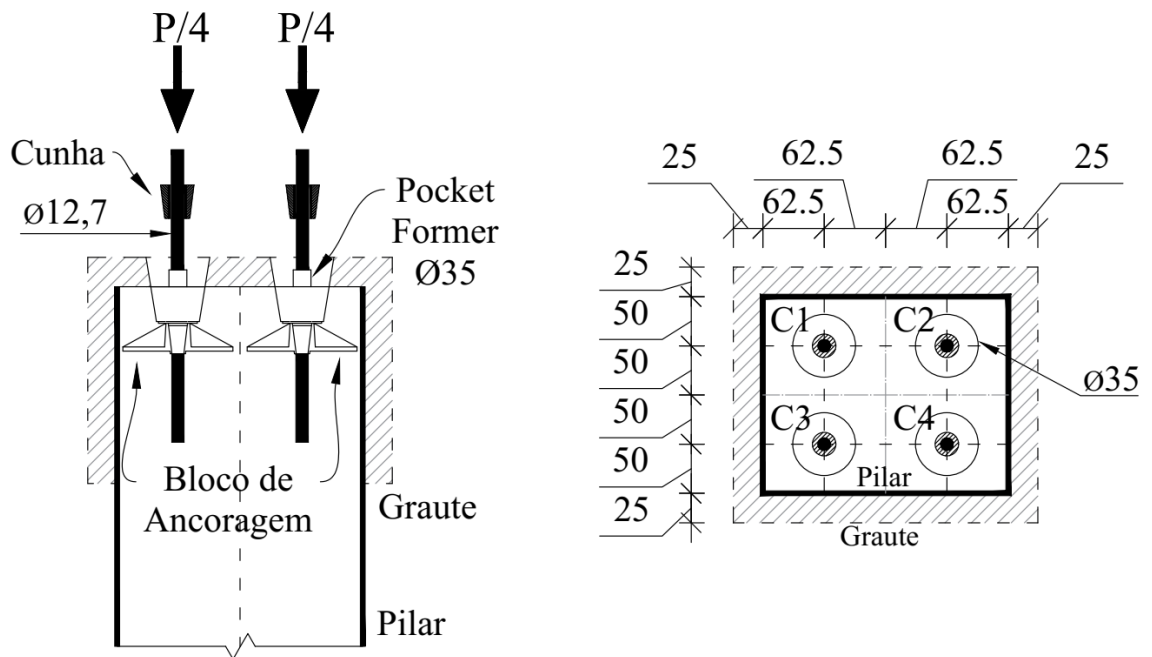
Detalhe da ancoragem e distribuição dos cabos para os pilares P1/P2
